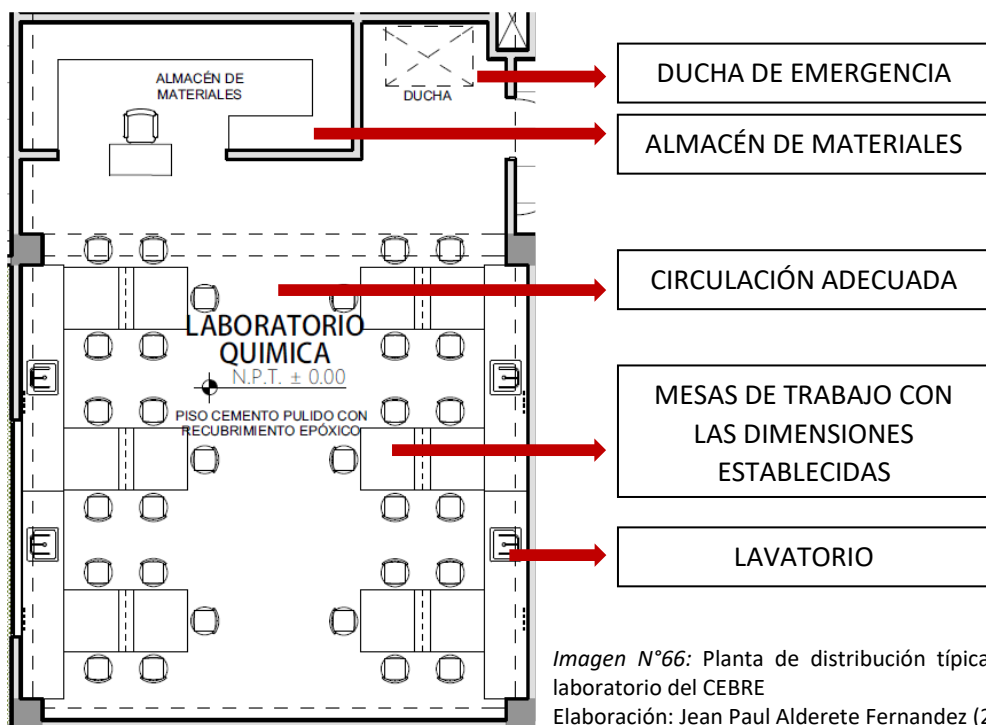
Planta de distribución típica de laboratorio del CEBRE
